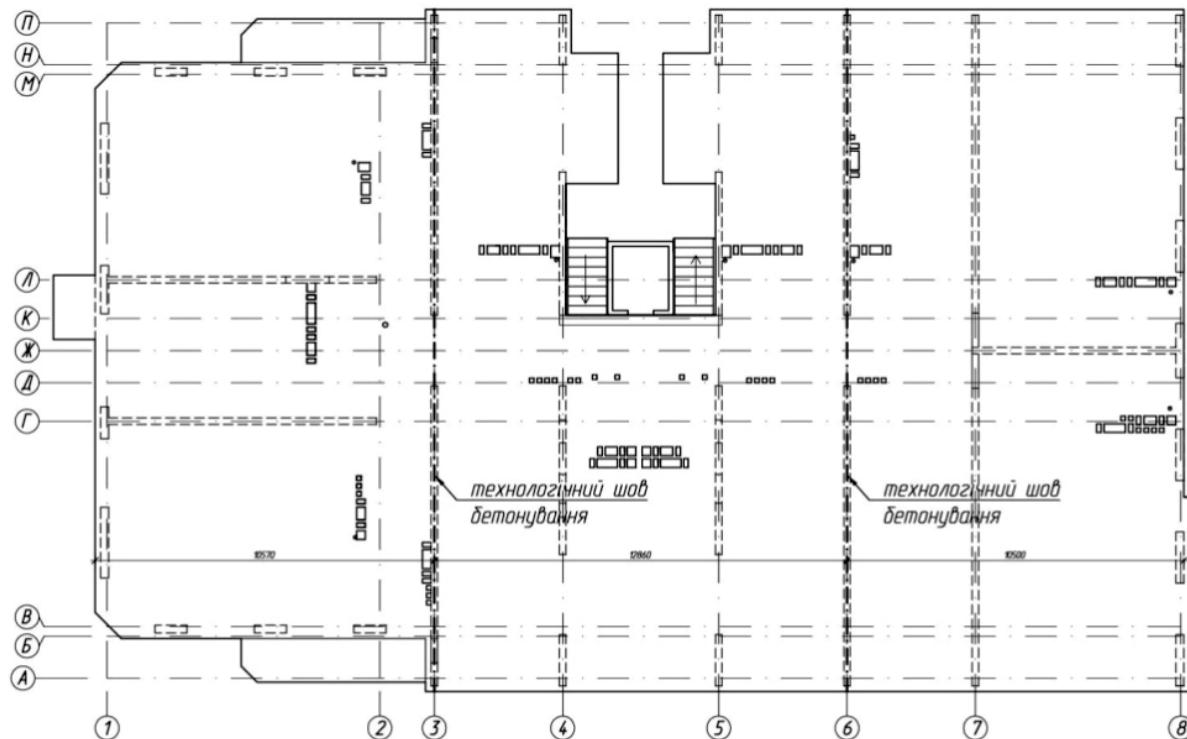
Розбивка на захватки при бетонуванні перекриття типового поверху будинку №3 по вул. Роксоляни у м. Львові
